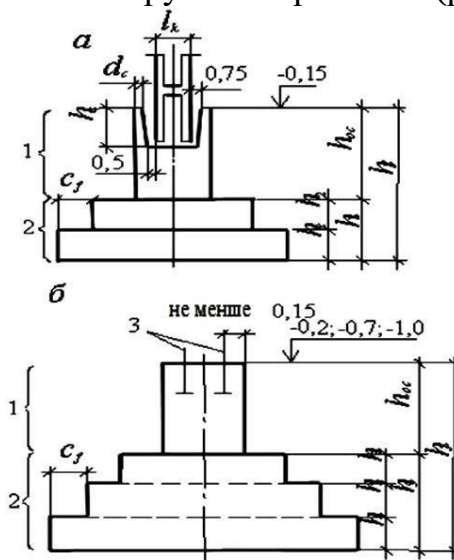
Стаканний фундамент для залізобетонних колон
